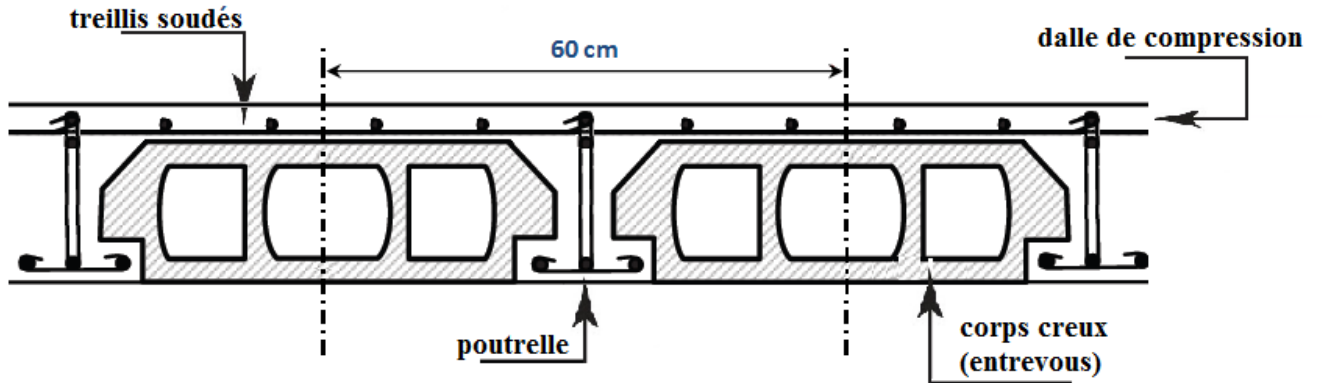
Coupe transversale d'un plancher à corps creux.
